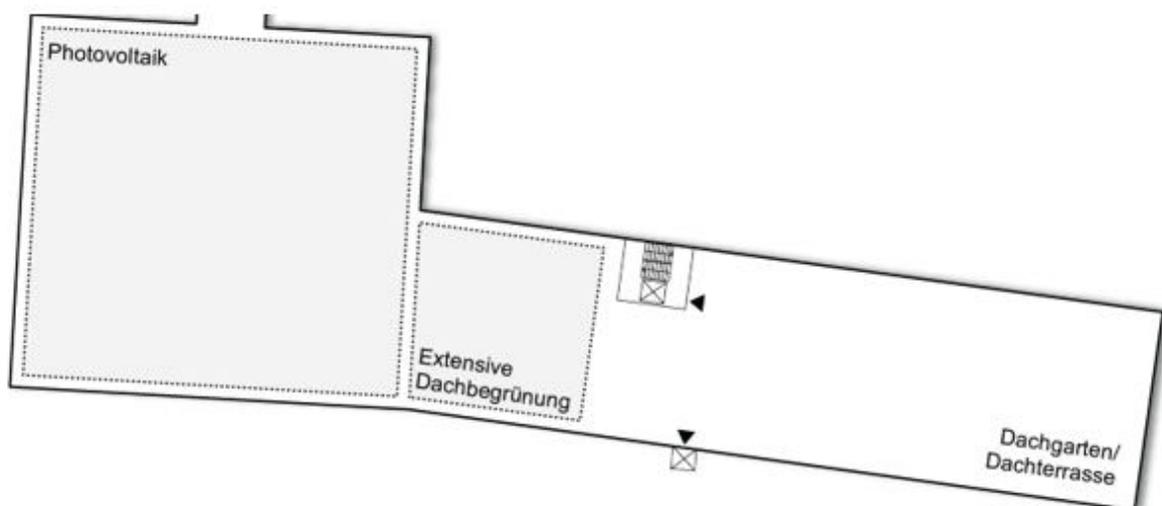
Funktionsgrundriss Parkhaus Dachlandschaft (o.M.)
